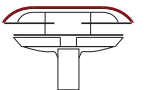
Detalle de la zona central de la cubierta. Momentos negativos en la zona de apoyo sobre la viga
